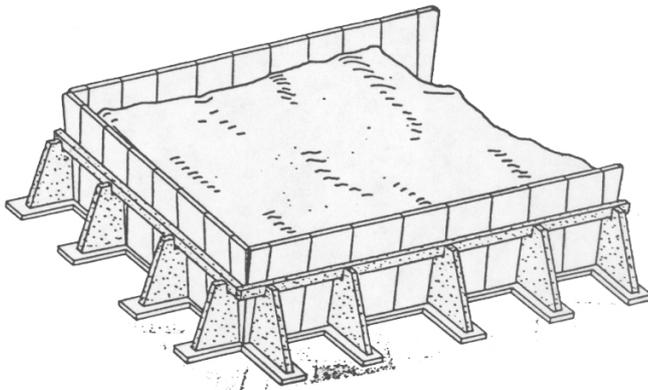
Silo couloir à murets en béton. (Source: Savoie et Jofriet, 1998).
